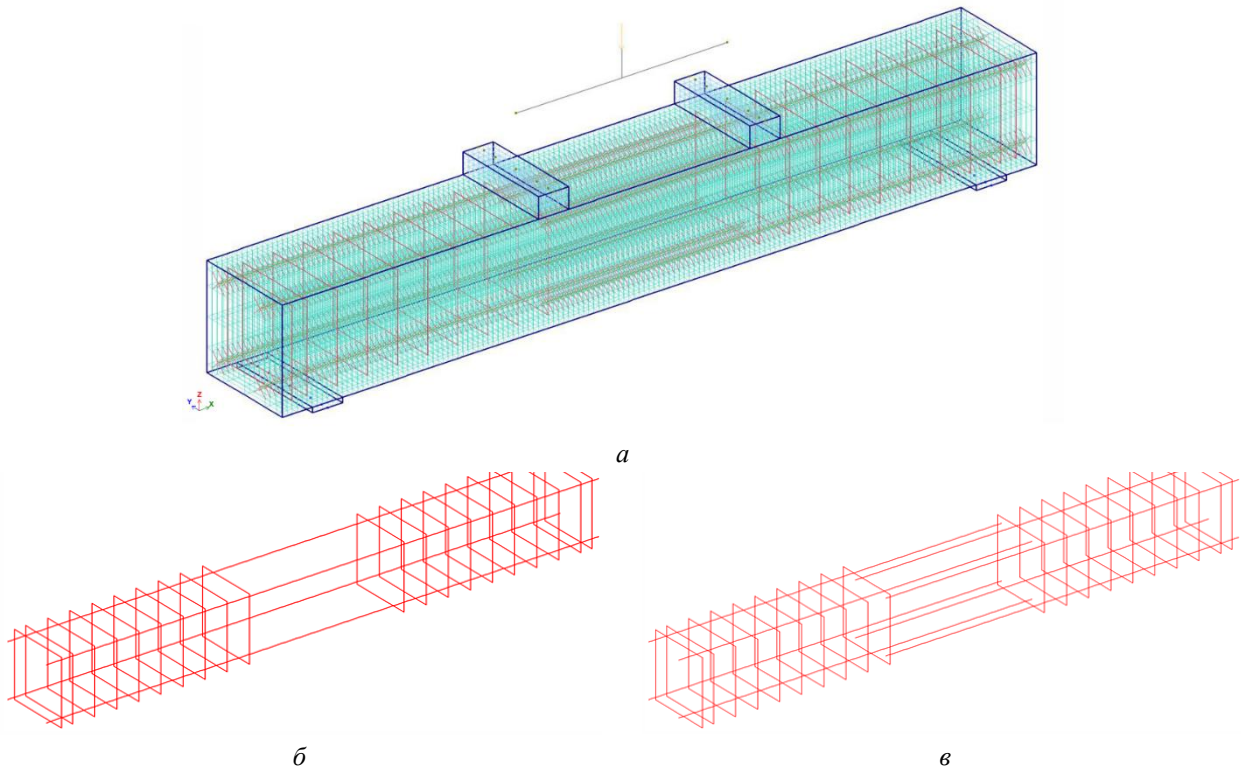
Конечно-элементные модели исследуемых железобетонных балок: *a* — общий вид, включая нагрузочные устройства; *б* — модель арматурного каркаса без перехлеста арматуры; *в* — модель арматурного каркаса с соединением продольной арматуры внахлест
